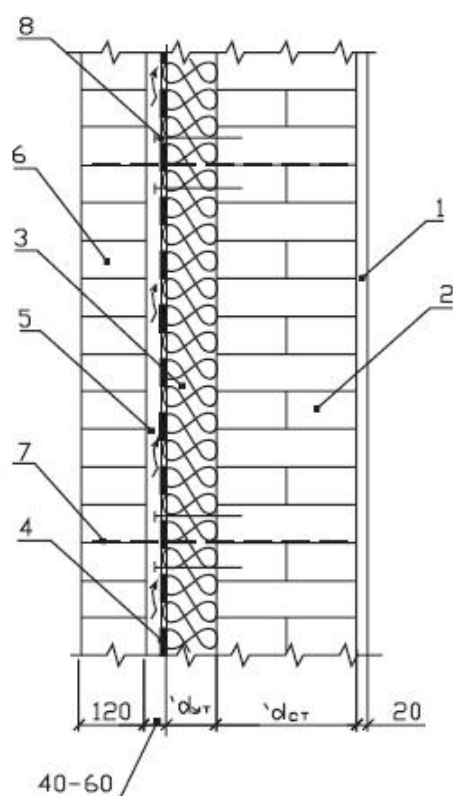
Кирпичная стена с теплоизоляцией из плит марки "ТЕРМО" в конструкции с облицовкой лицевым кирпичом по деревянному каркасу без вентилируемого зазора. Вариант. (реконструкция)
